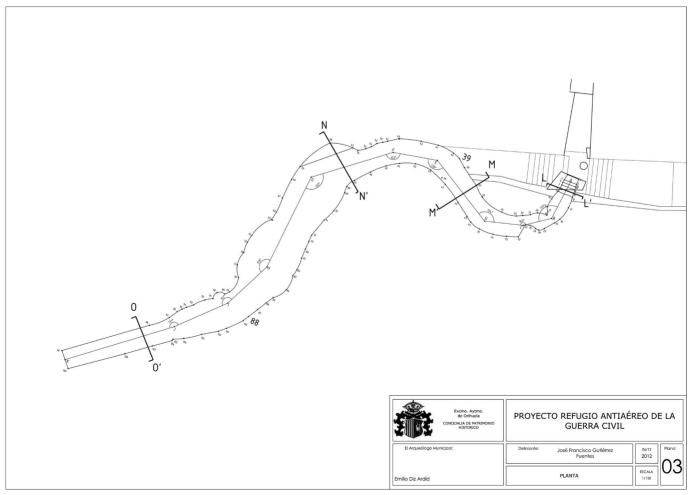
Planimetría del refugio de la Calle Santa Justa
